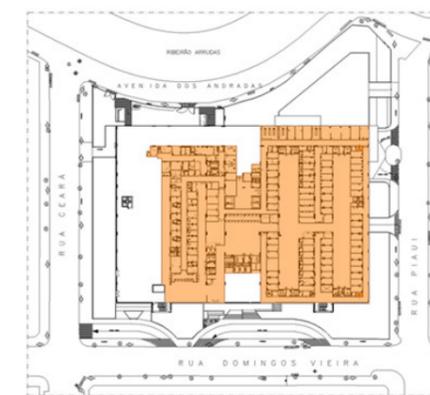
Planta de situação - Pavimento térreo - Centro de Especialidades Médicas (CEM-SCBH)
